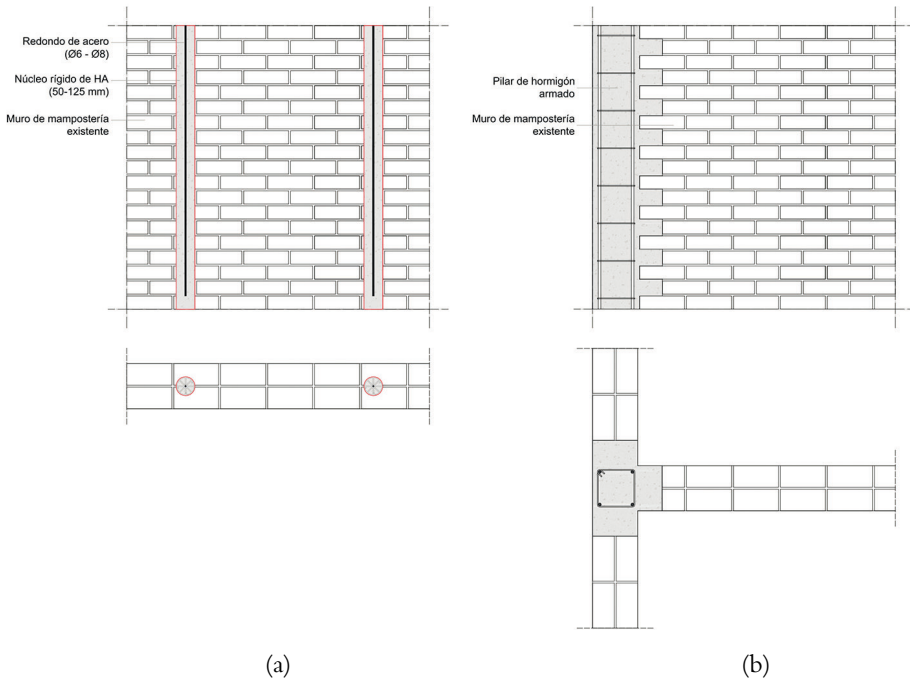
Actuación general con elementos de hormigón armado. (a) núcleo rígido y (b) confinamiento con pilares y vigas de HA. Esquemas y detalles constructivos.
